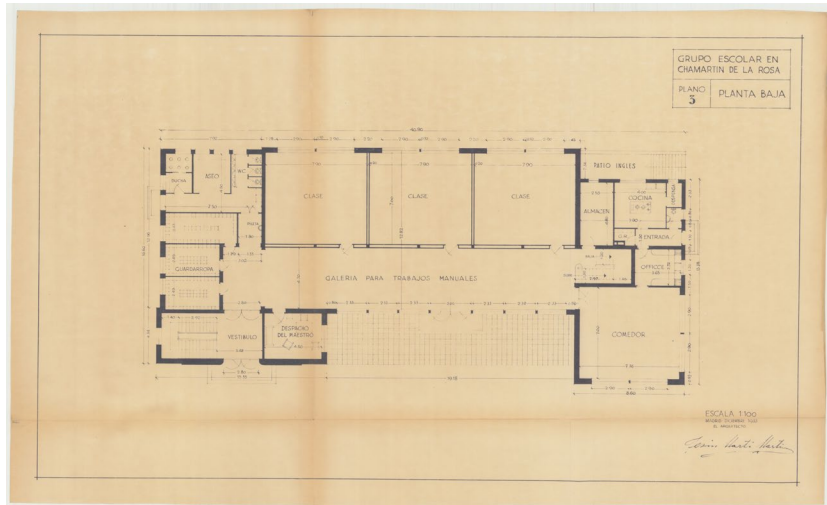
Grupo escolar en Chamartín de la Rosa (1933). Planta baja.
